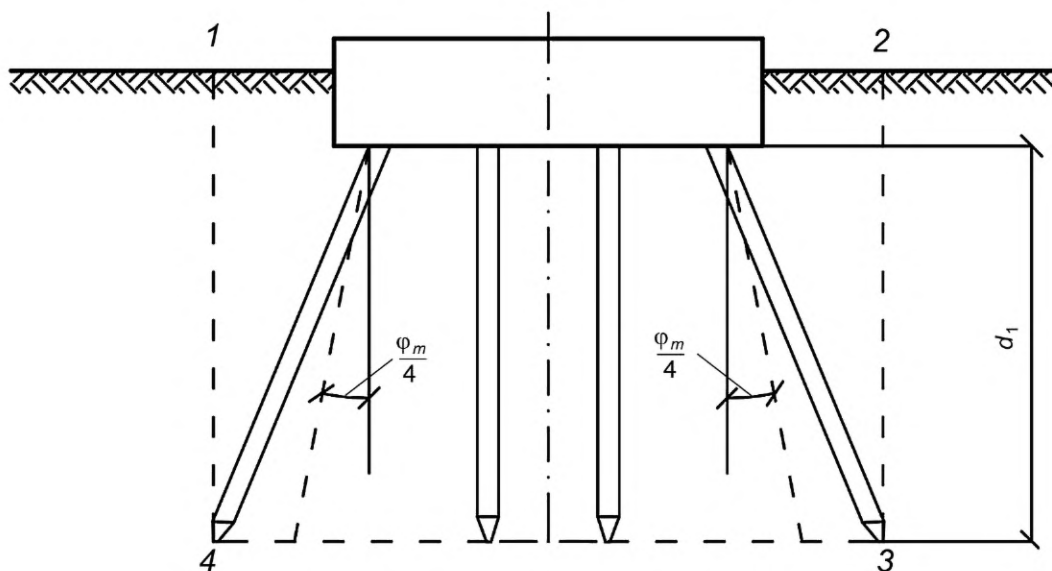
Условный свайный фундамент с ростверком, заглубленным в грунт, при угле наклона свай более $\varphi_m/4$
